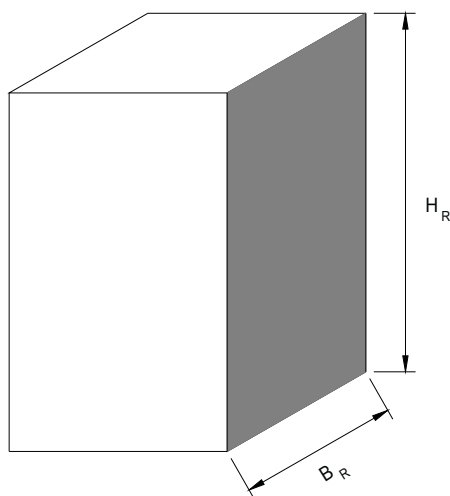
Bezeichnungen an aufgehenden Fassaden
